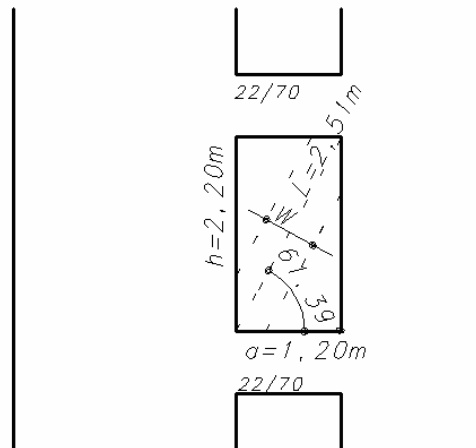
Pórtico 8=Pórtico10(segundo proposta de Moreira,2002)
